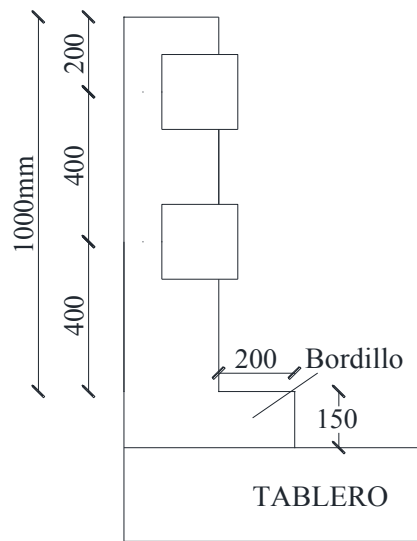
Protección lateral vehicular con poste de hormigón armado y vallas vehiculares metálicas
